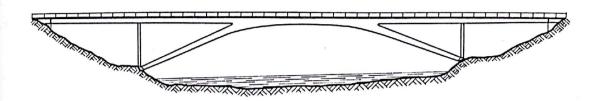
PÓRTICO COM PILARES INCLINADOS
